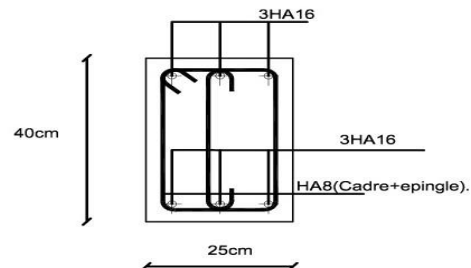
Plan de ferrailage des poutres principales. (PPLV)
